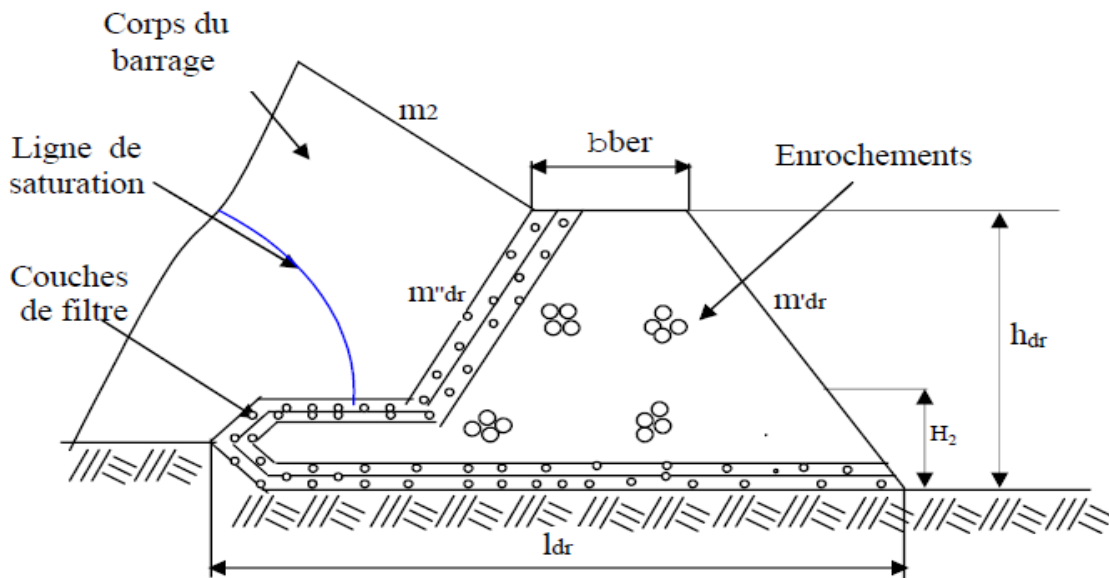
Prisme de drainage avec drain tapis interne sur fondations perméables (Messaid, 2002).
